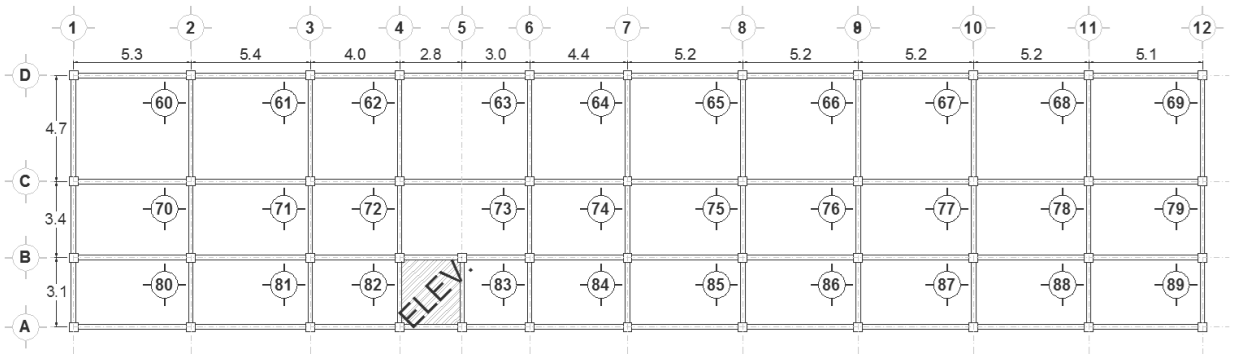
Vista en planta de losas de tercer nivel.
